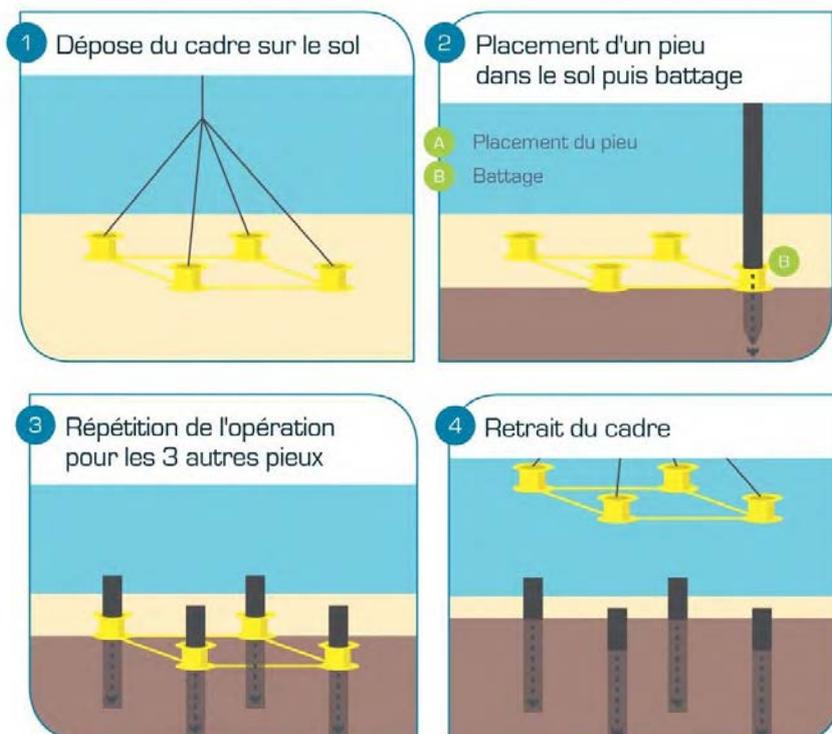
Cadre permettant l'installation des pieux d'une fondation Jacket
